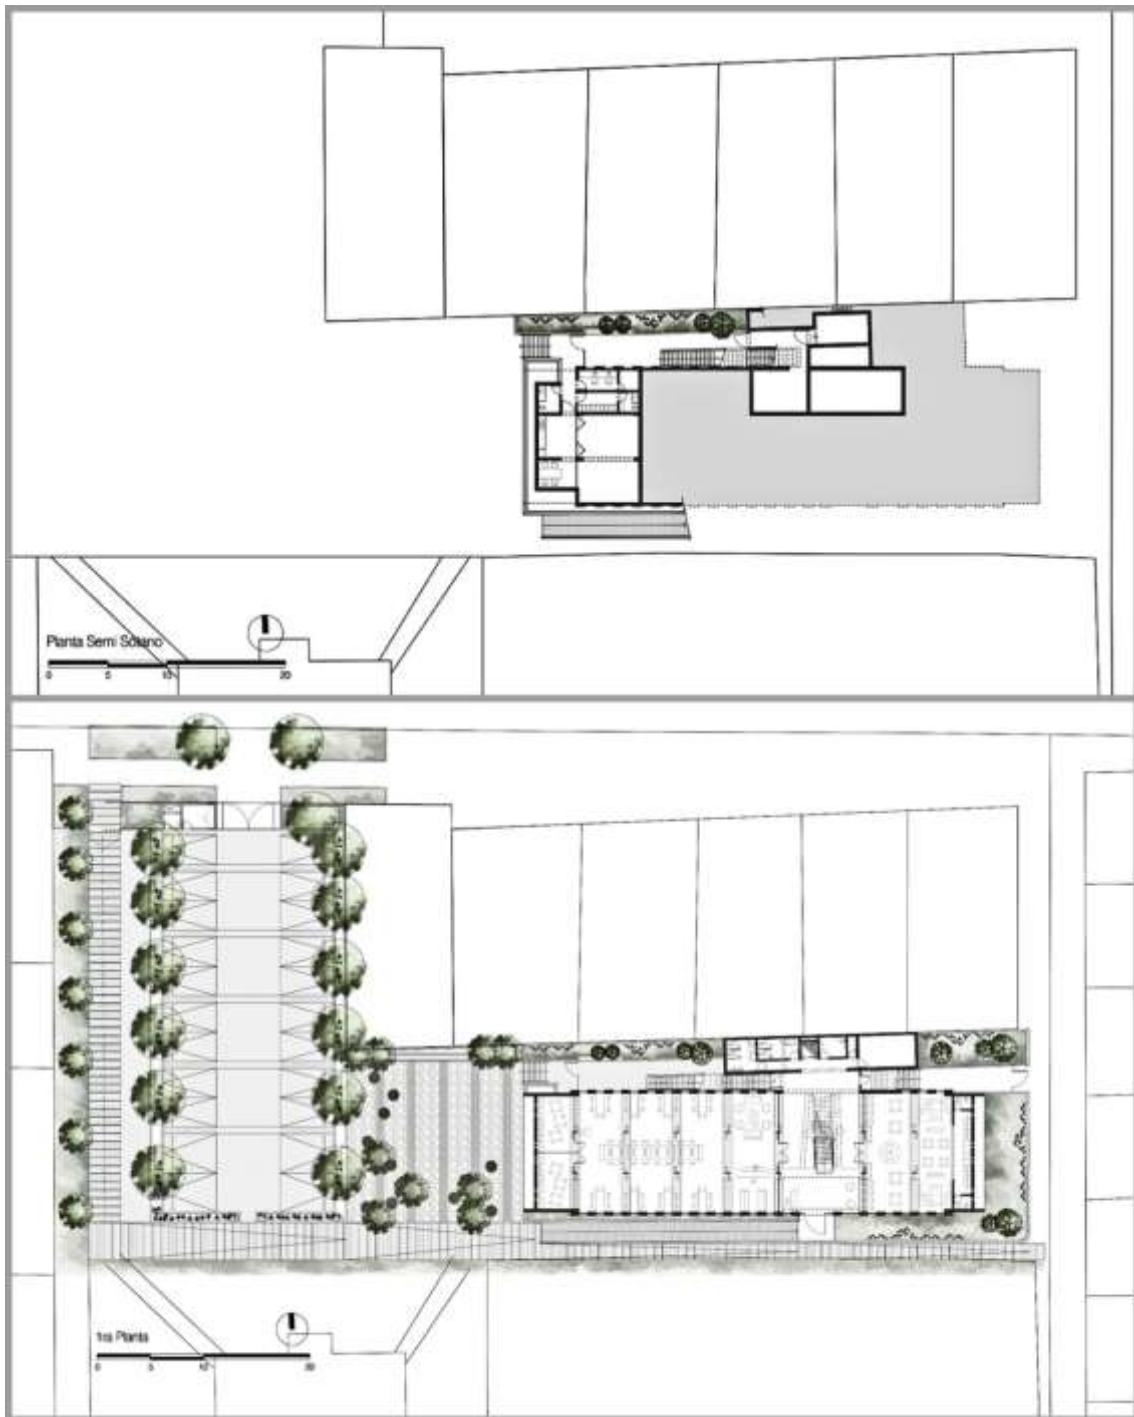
Sótano y 1ra planta de la Plaza Biblioteca La Molina
